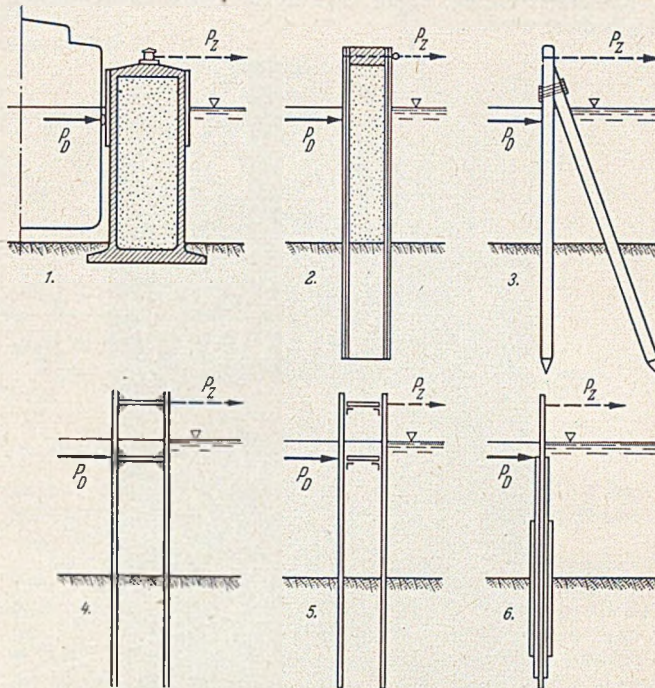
Die 6 Grundtypen der Dalbenbauweise.
